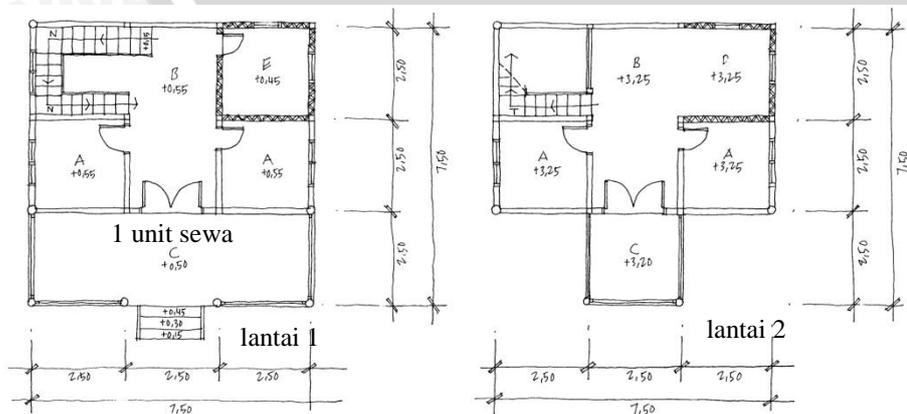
Denah cottage tipe A Hotel Wisata Pantai Camplong.
